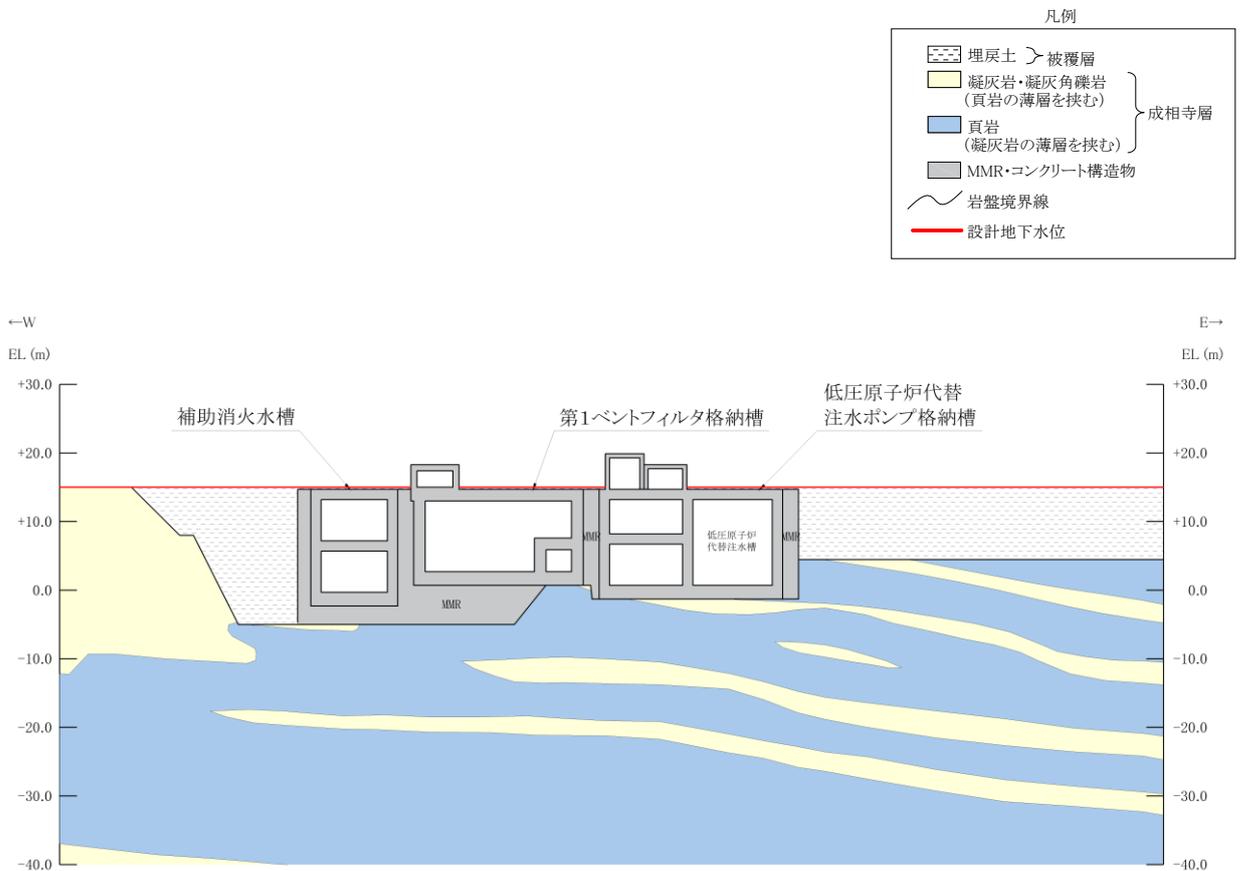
第1 ベントフィルタ格納槽 地質断面図 (C-C 断面)
